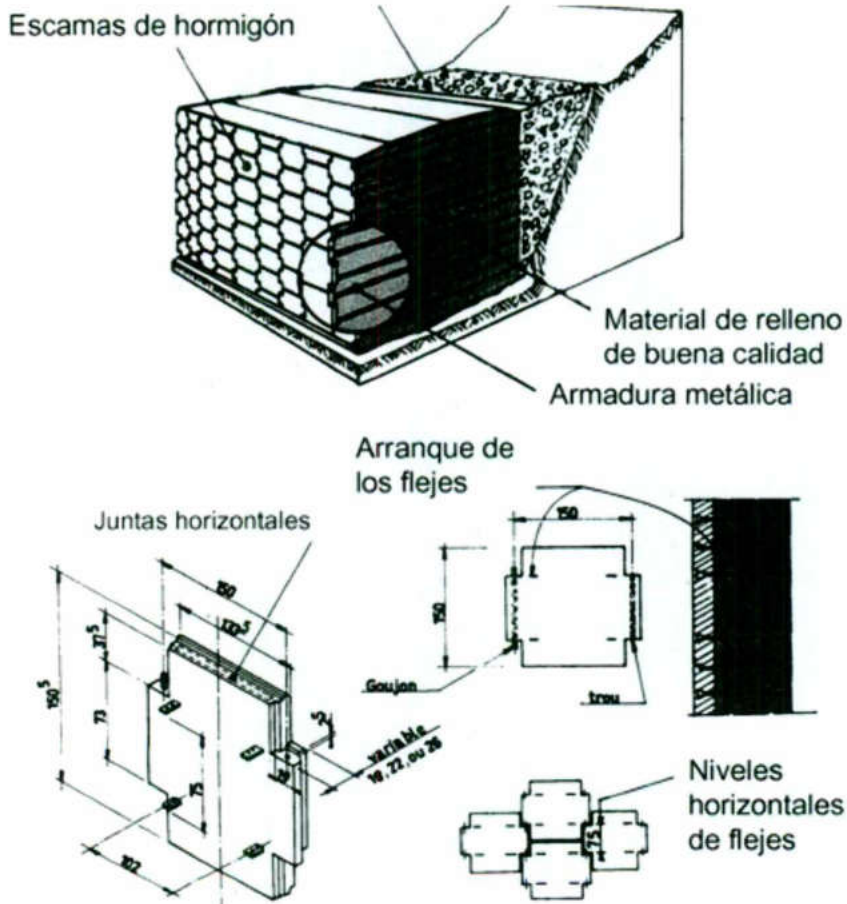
Esquema General de la Construcción con Tierra Armada. (Braja M. Das, 2006)
